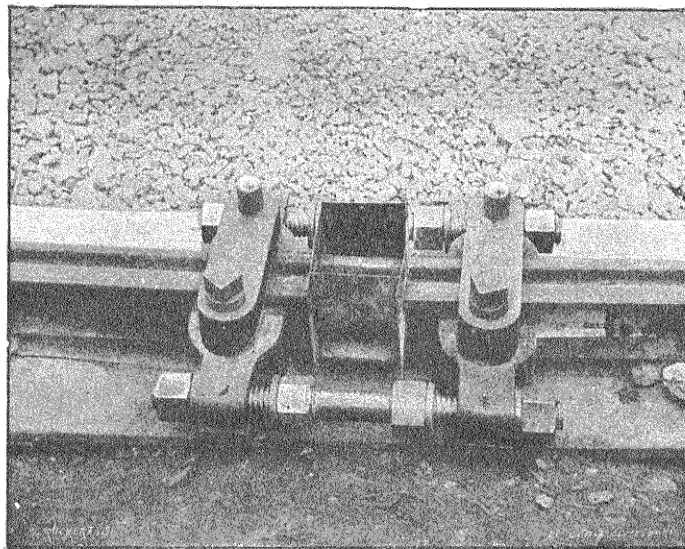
Dispositif pour la soudure des rails à l'aluminium (procédé Goldschmidt).
